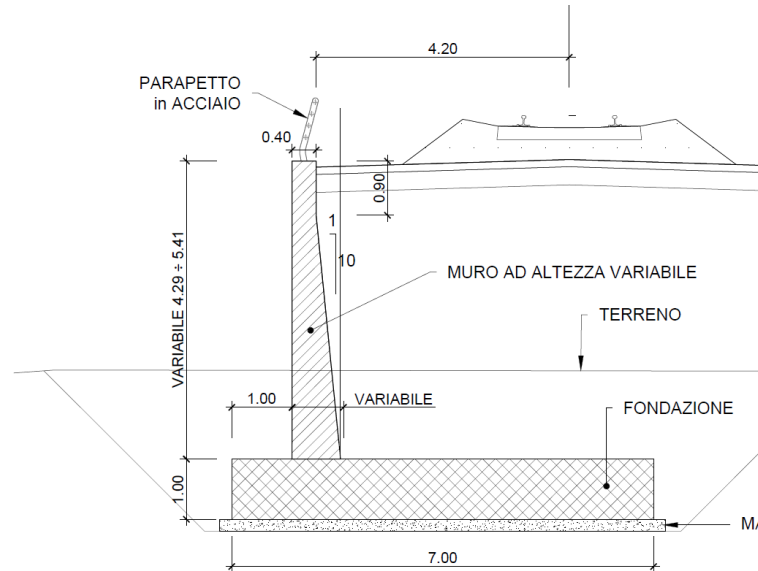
Sezione muro di sostegno MU71 – Muro TIPO 2
